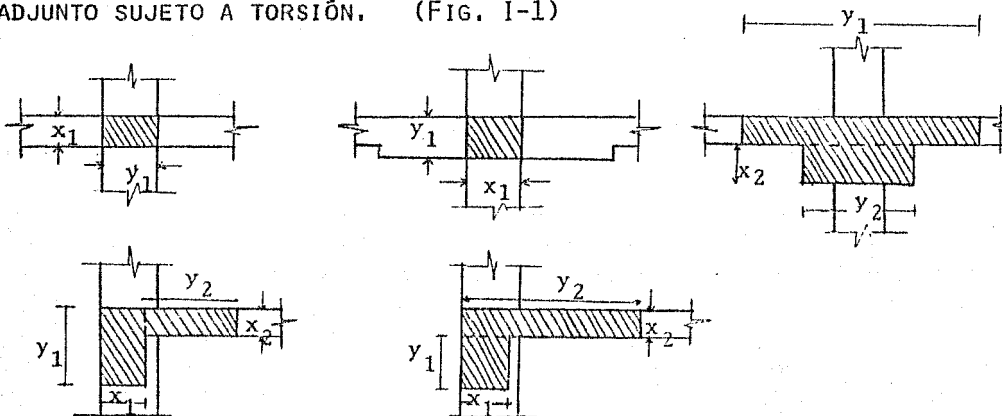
SECCIONES TRANSVERSALES PARA DETERMINAR EL PARÁMETRO C DE LA VIGA SUJETA A TORSIÓN.
